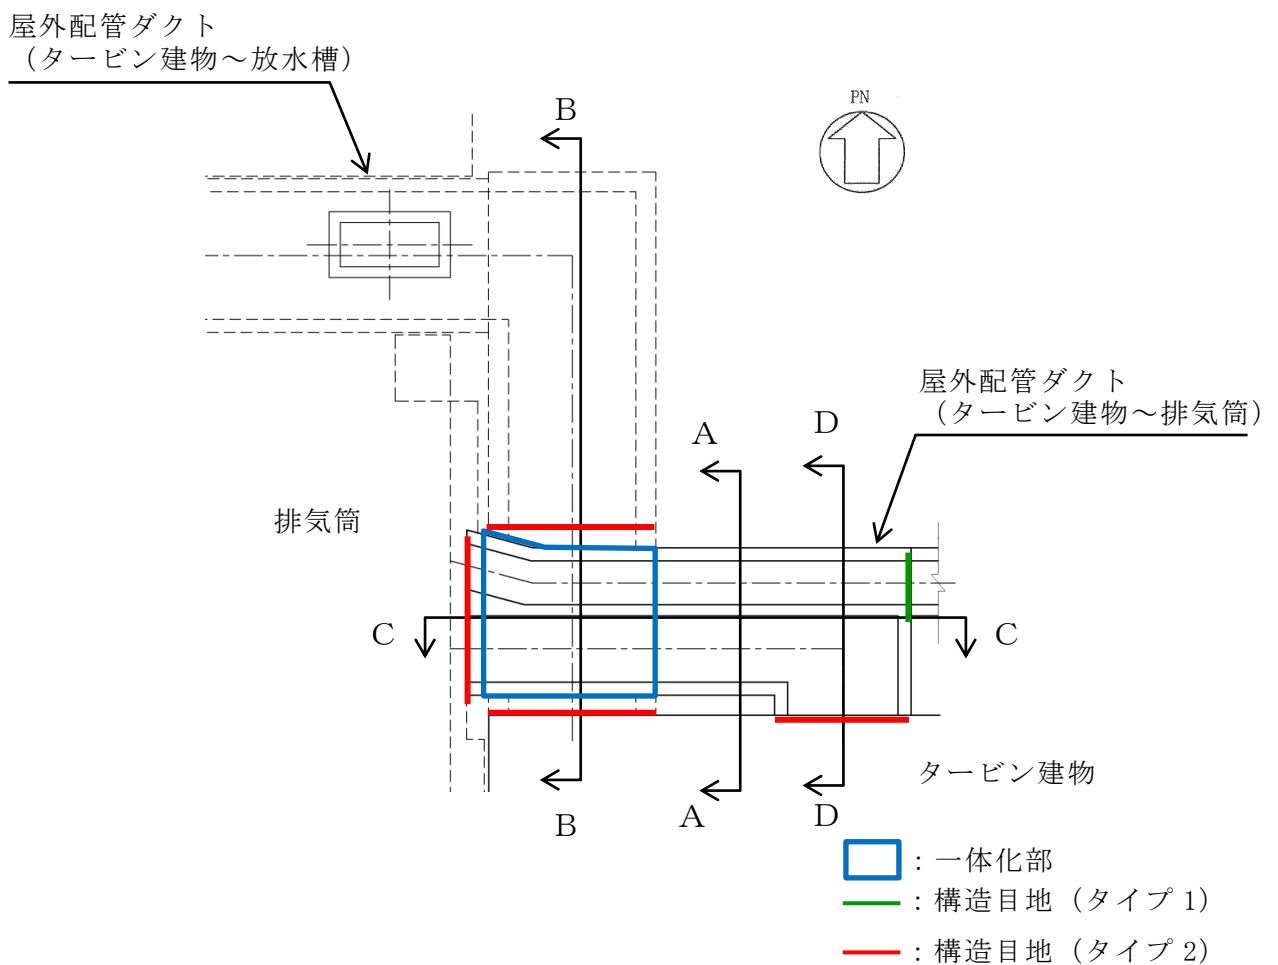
屋外配管ダクト（タービン建物～排気筒） 平面図
